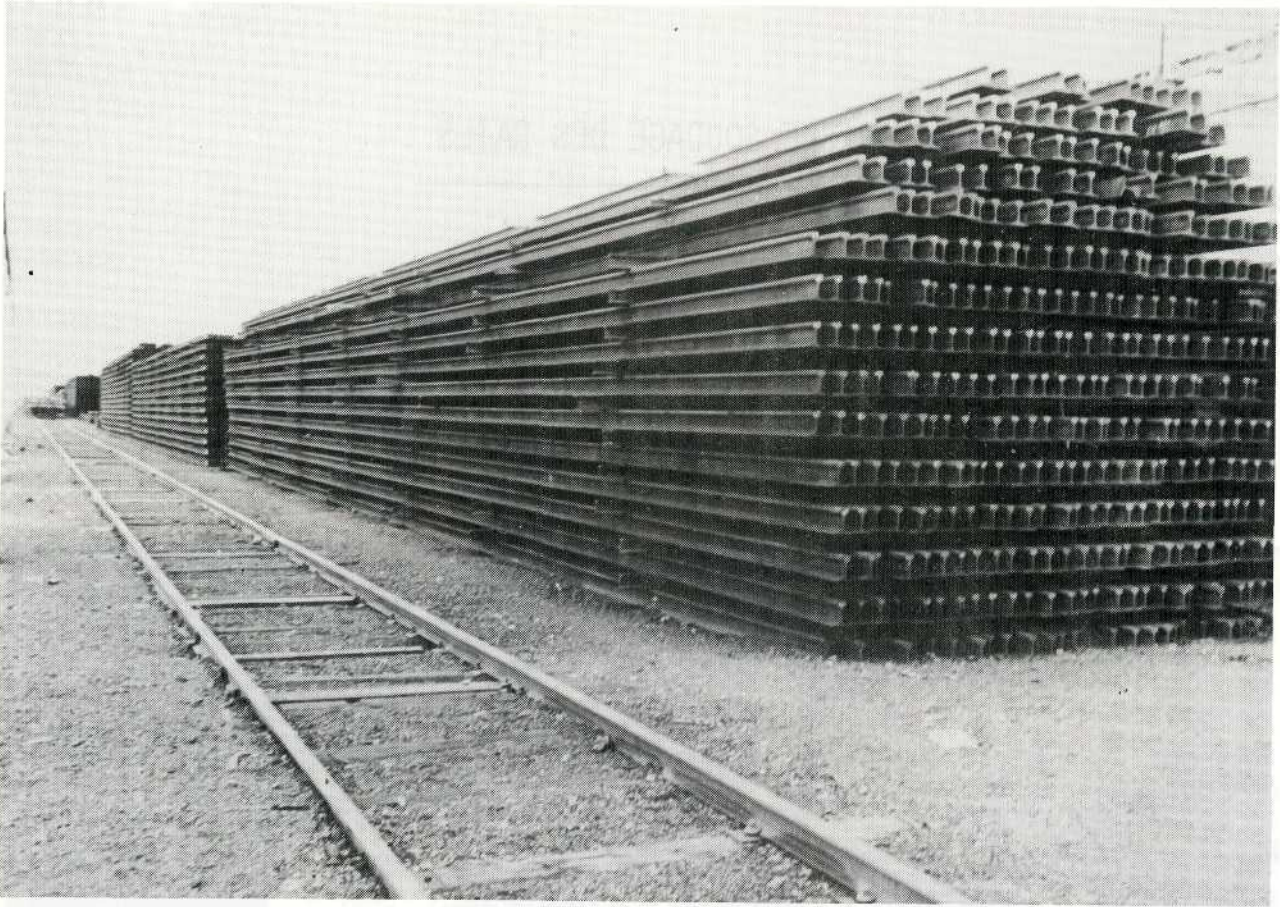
Rails stockés en piles en attente d'être soudés.
